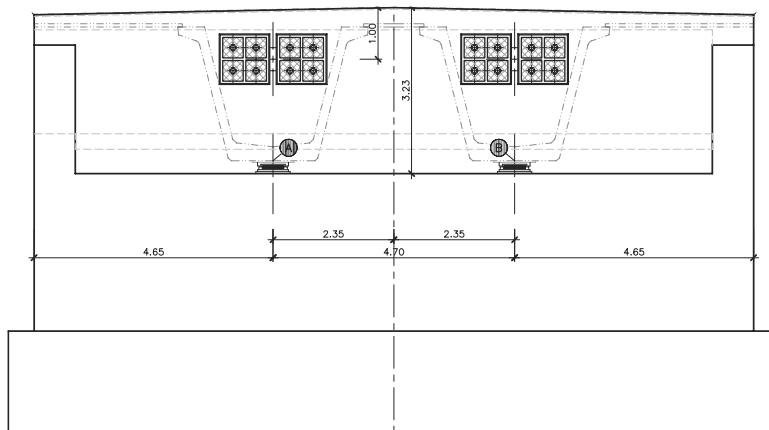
Estribo fijo de tablero de vigas prefabricadas continuas
